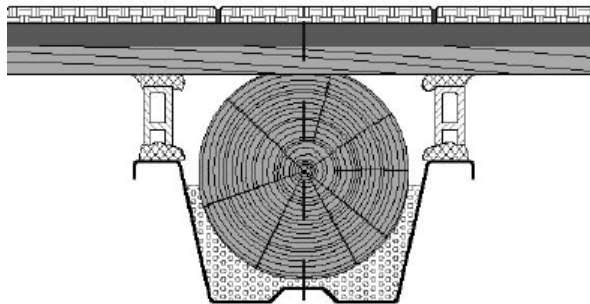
Sección viga reforzada con sistema estandarizado “NOU/BAU”
